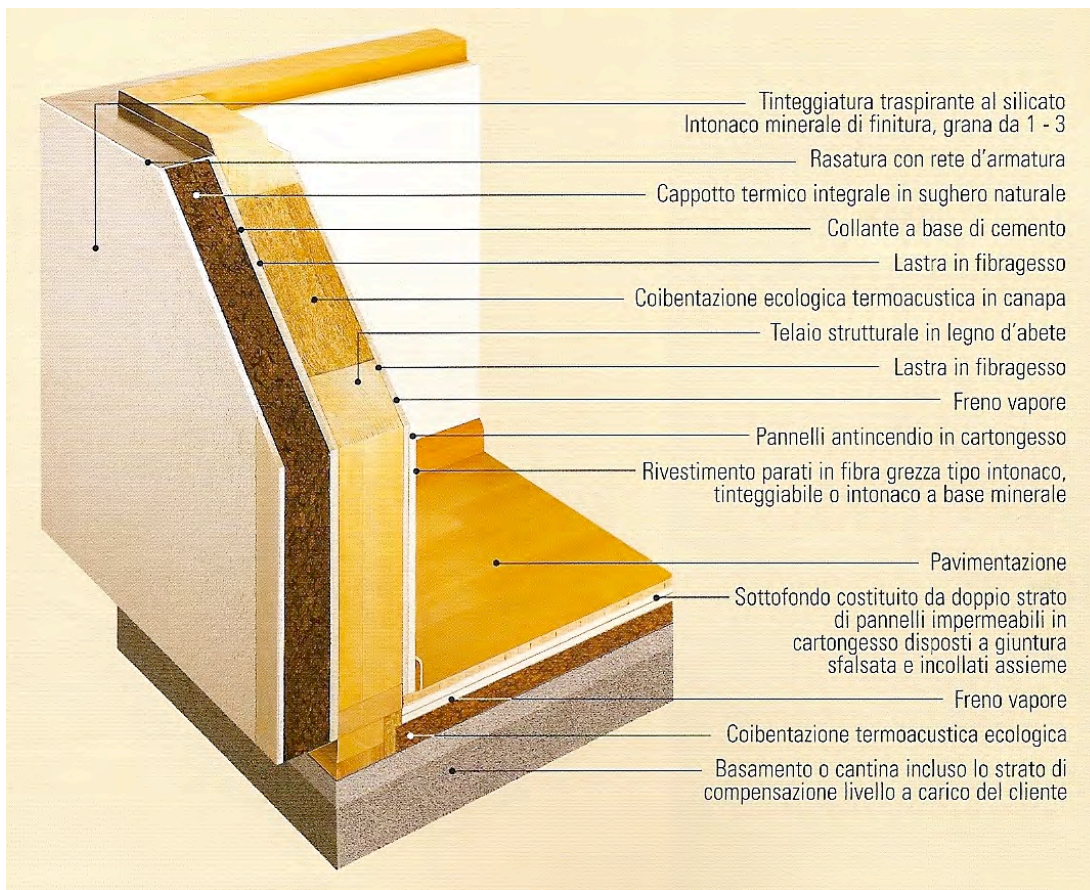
Pacchetto parete a telaio e lastre - fonte: catalogo Rubner
